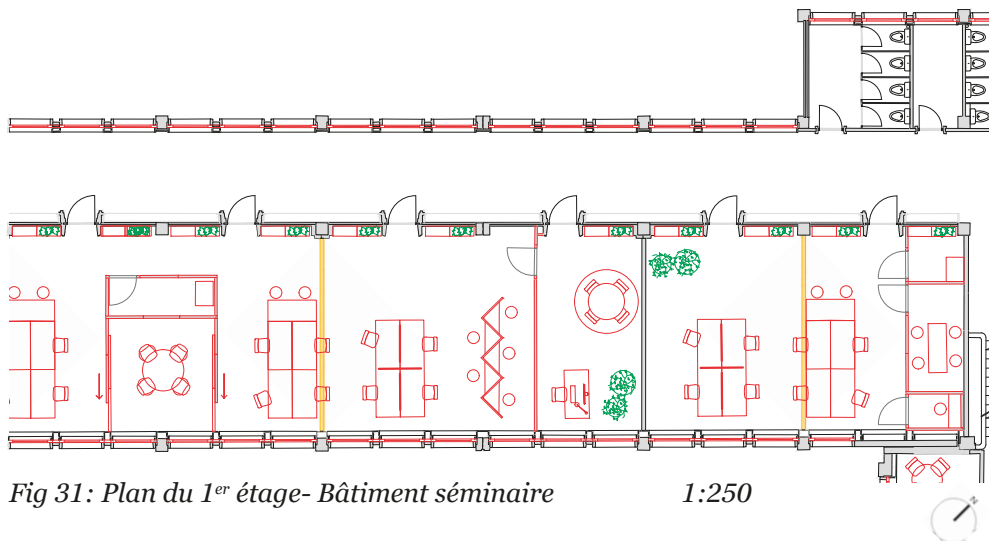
Plan du 1^{er} étage- Bâtiment séminaire
